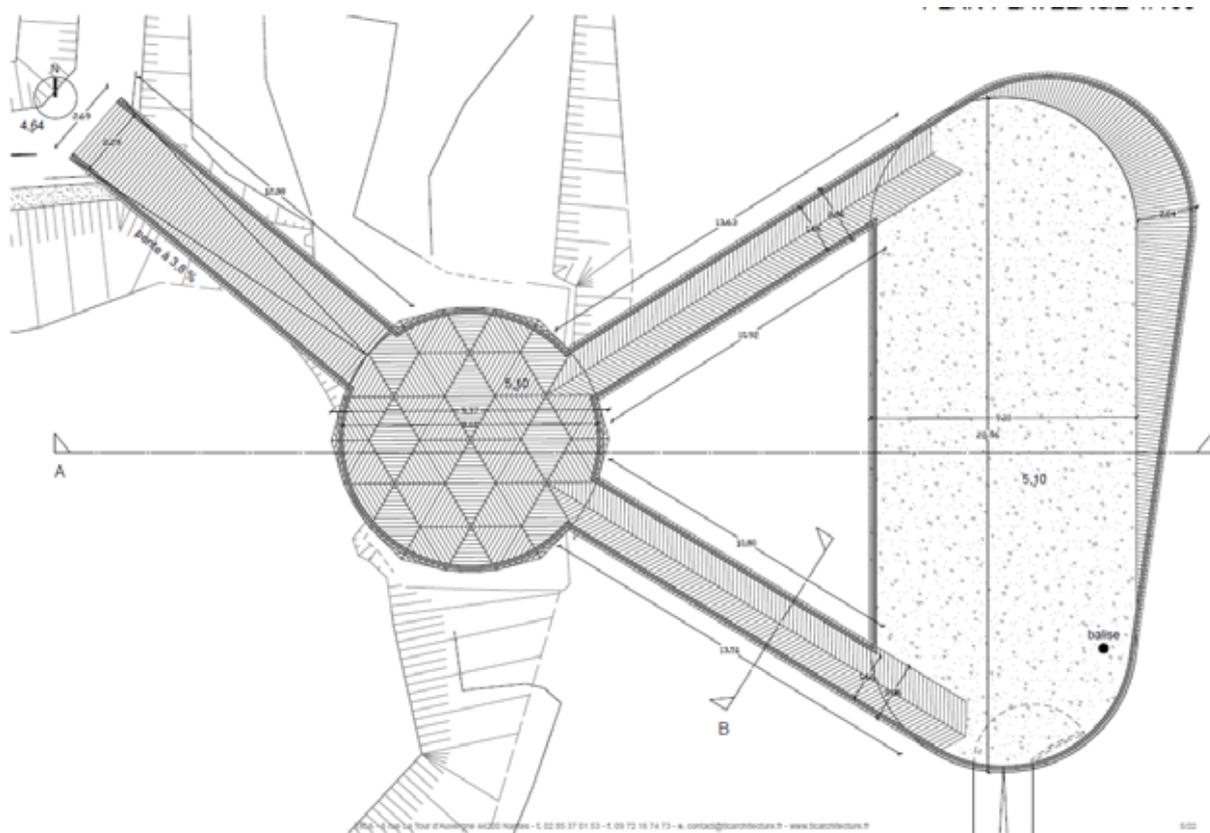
Plan des platelages - Rampes et plateformes - Soucre TICA SCE up+
